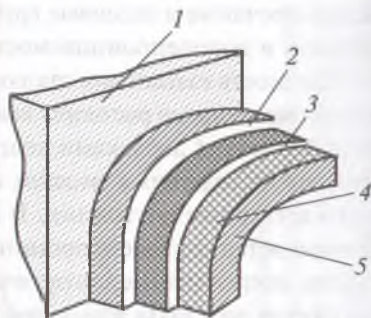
Общий вид и схема наружной гидроизоляции обделки:
